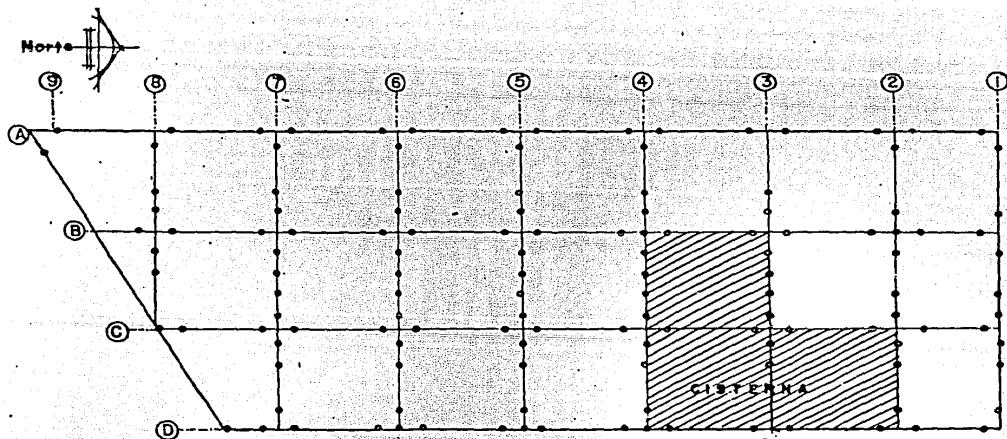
DISTRIBUCION DE PILOTES Y PLANTA DE CAJON ORIGINAL
